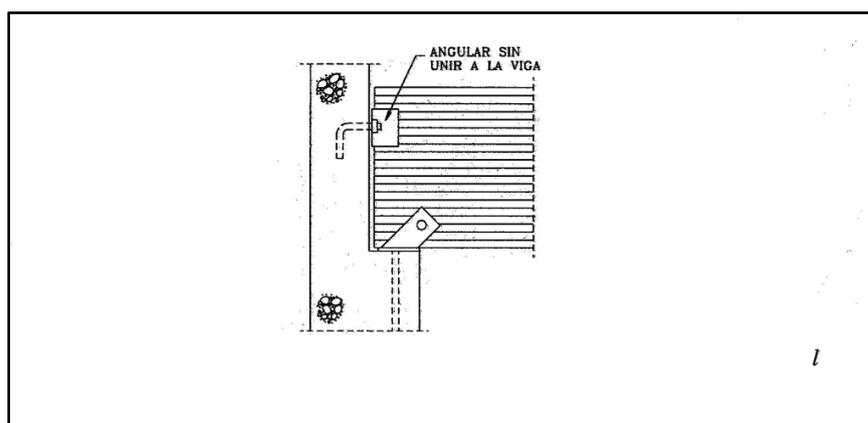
Disposición para impedir el vuelco de la viga sin restringir el giro de apoyo.
